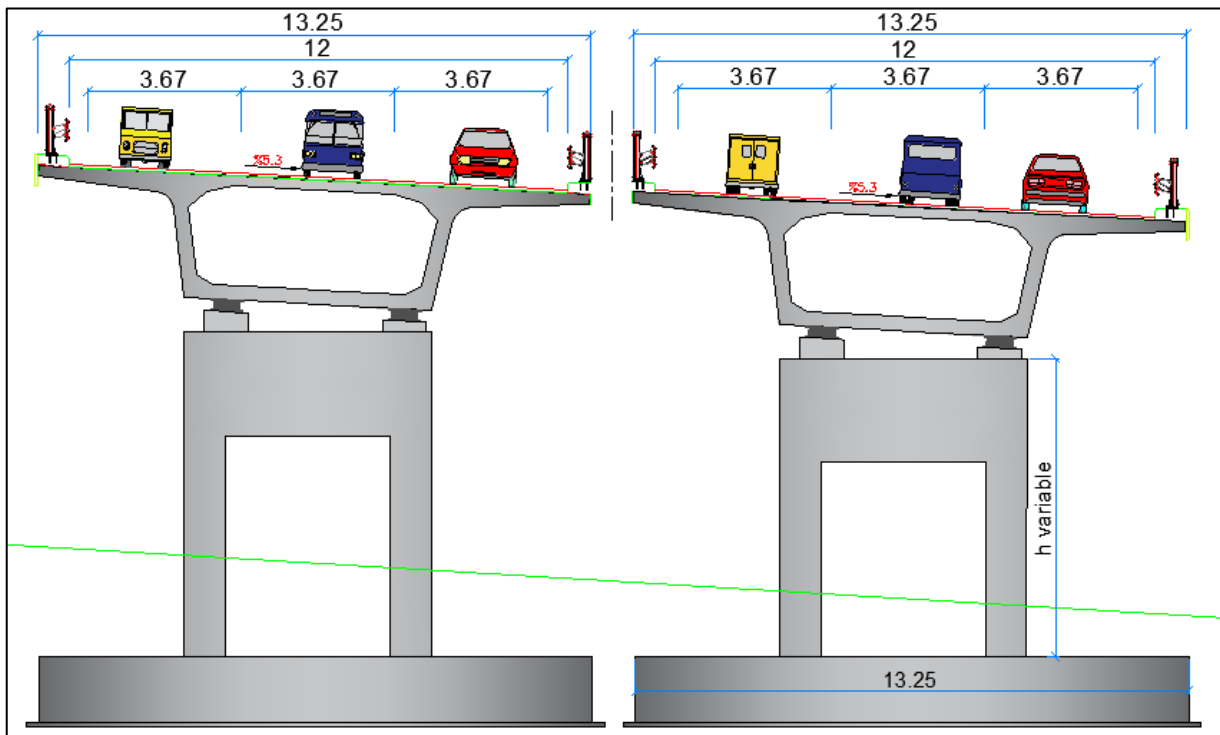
Coupe transversale sur pile VARIANTE 02
